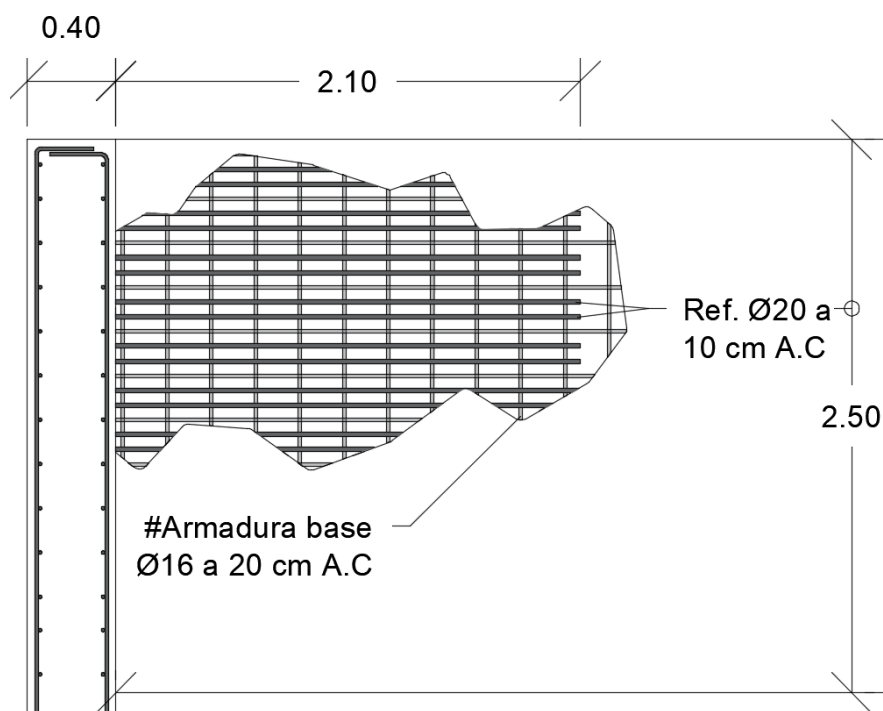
Refuerzo en muro interno 3 exterior (armadura horizontal)
